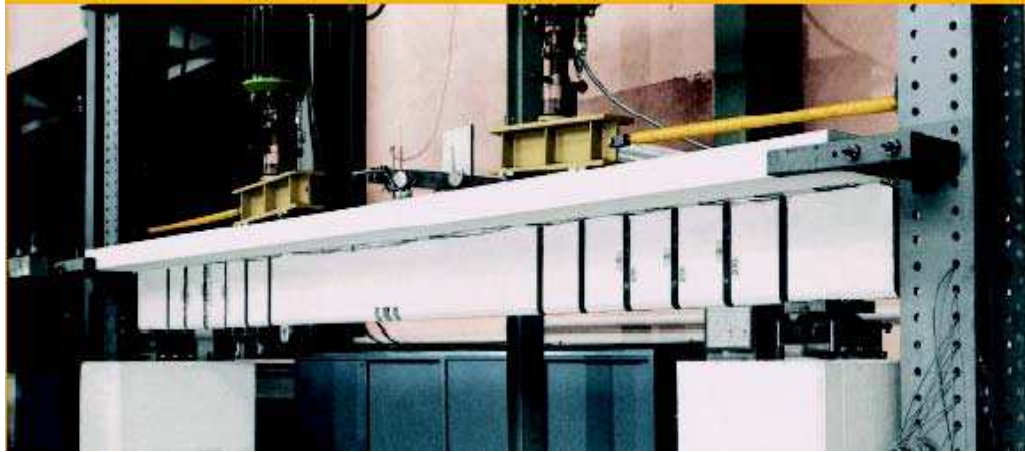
Viga reforçada ao cisalhamento no EMPA (SIKA, 2003).
